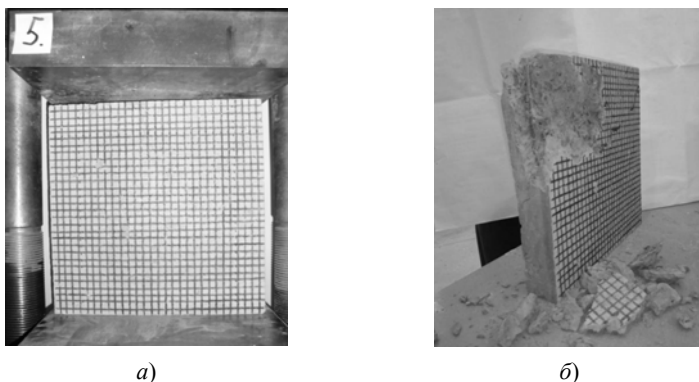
Испытание модели стены, армированной арматурной сеткой, под действием распределенной нагрузки:
